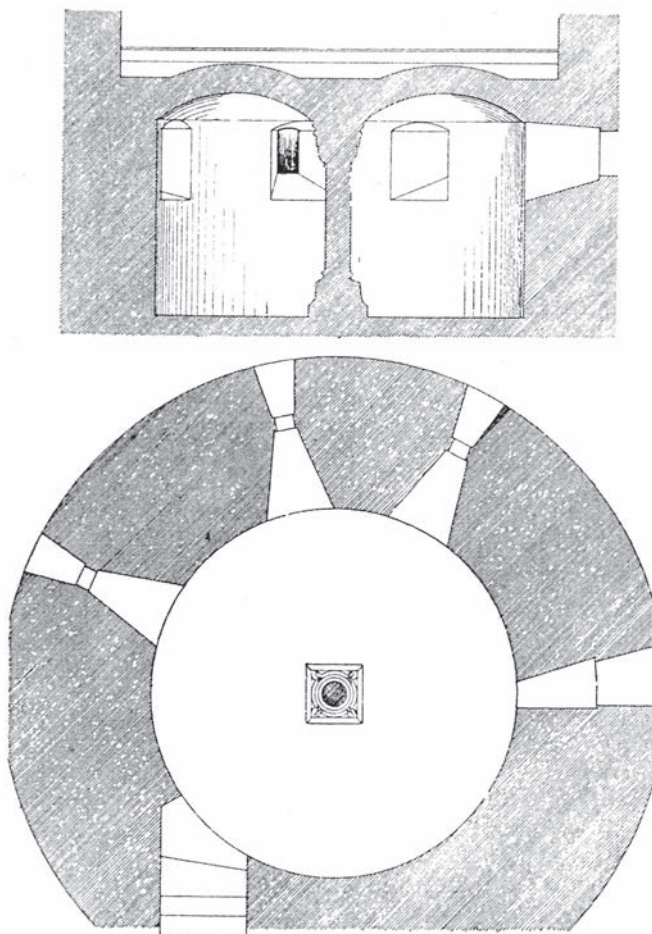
Wölchingen, Johanniterkirche, Krypta, Grundriss (Osten ist oben) und Schnitt (Blick in Richtung Osten)
